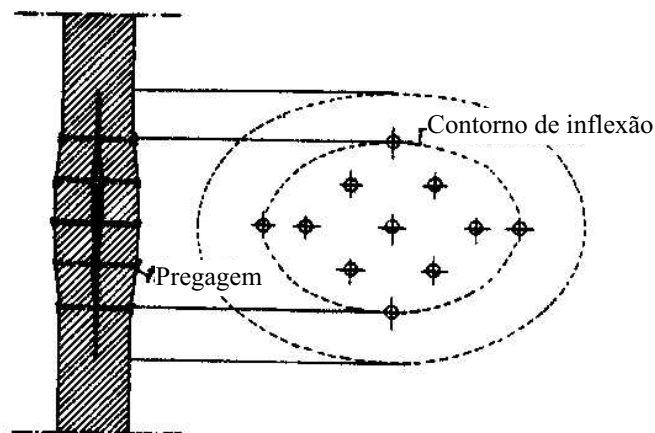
Aplicação de pregagens transversais a uma parede (Piccirilli, 1996).
